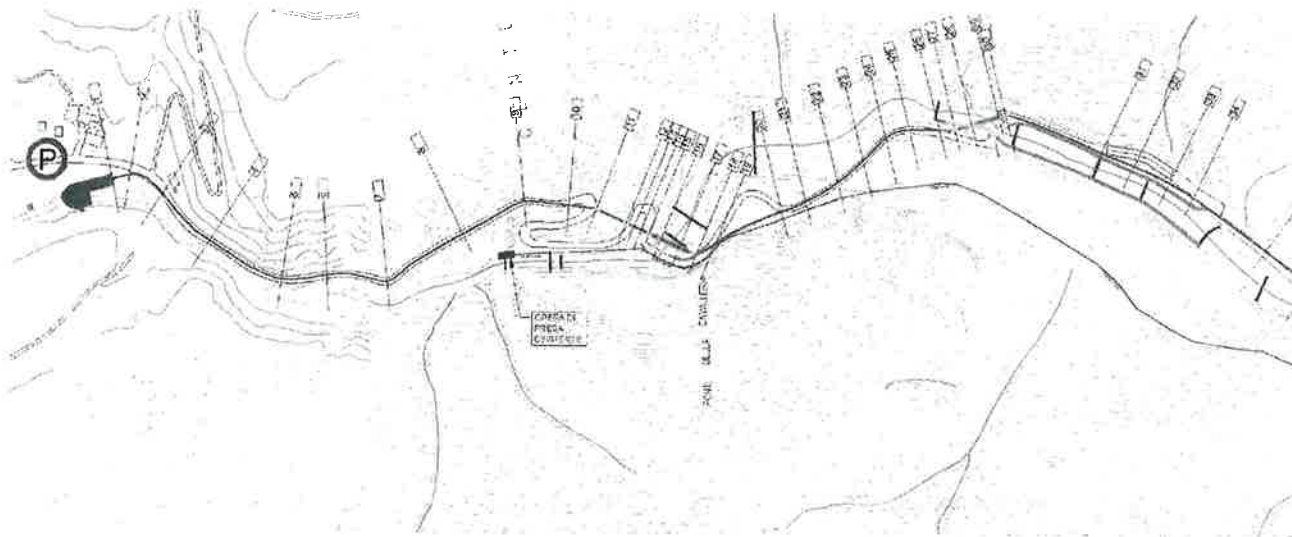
Planimetria della condotta forzata nel tratto a monte dell'attraversamento del ponte stradale
